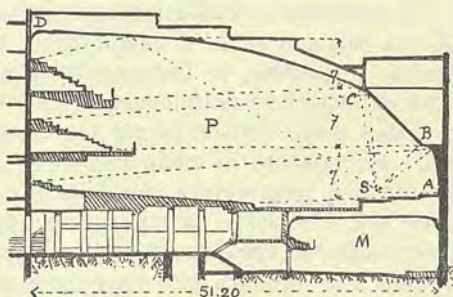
Sezione longitudinale della sala Pleyel di Parigi.
